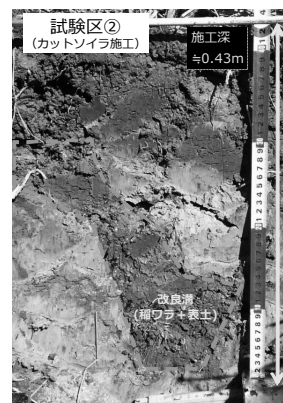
有材施工1年後の断面 (H28 秋施工 変状なし)
